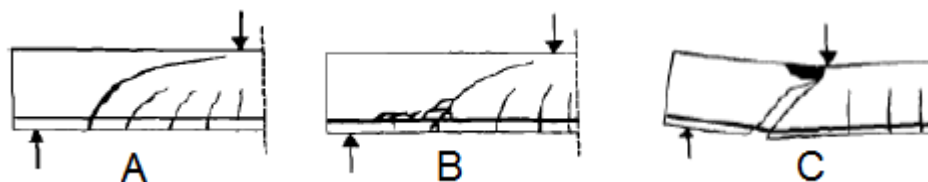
Tipos de rotura para uma viga armada longitudinalmente. (adaptada de Birgisson, 2011)
